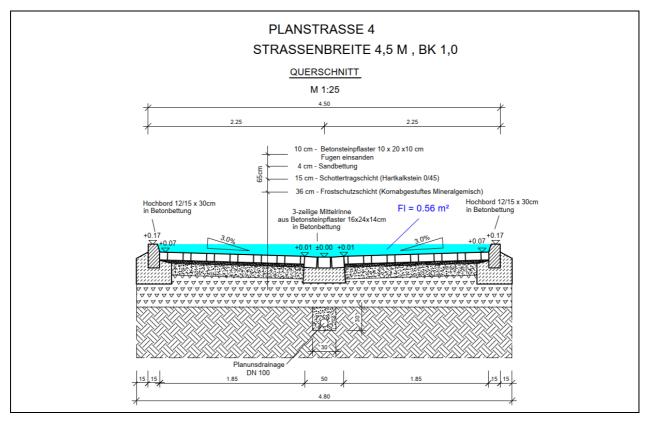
Baugebiet "Bellingholz-Süd", Querschnitte Planstraßen, DW- Ingenieure GmbH, unmassstäblich
